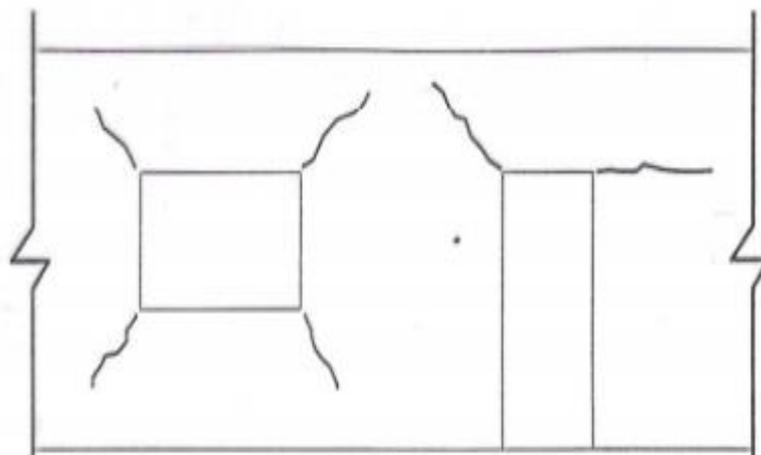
Trinca horizontal proveniente de sobrecarga
